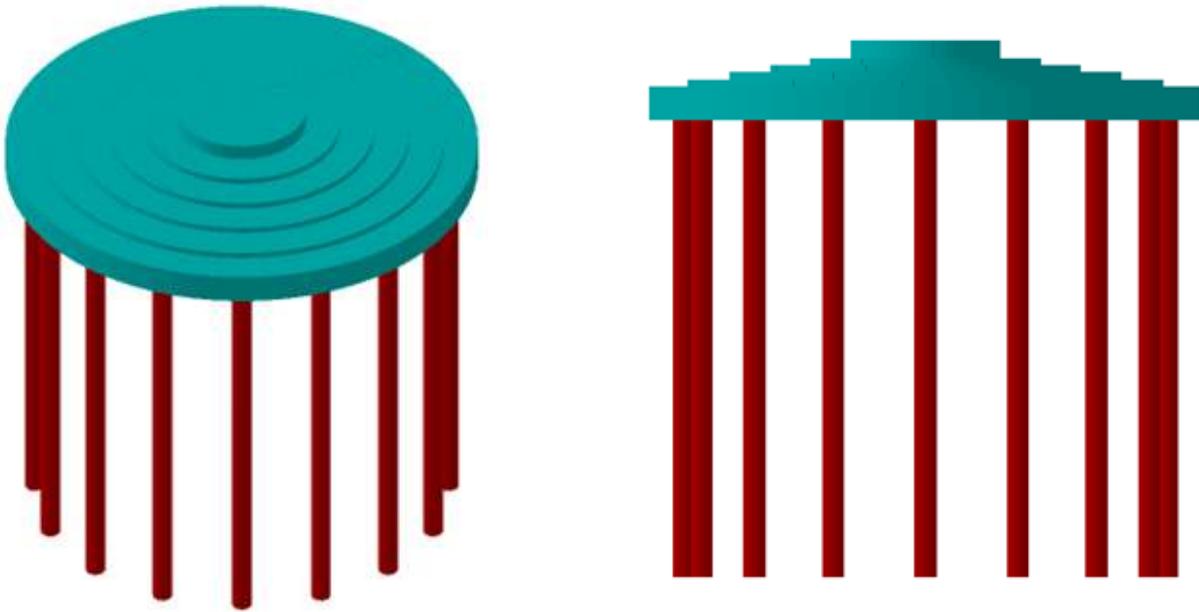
Vista 3D e vista XZ fondazione tipo.
